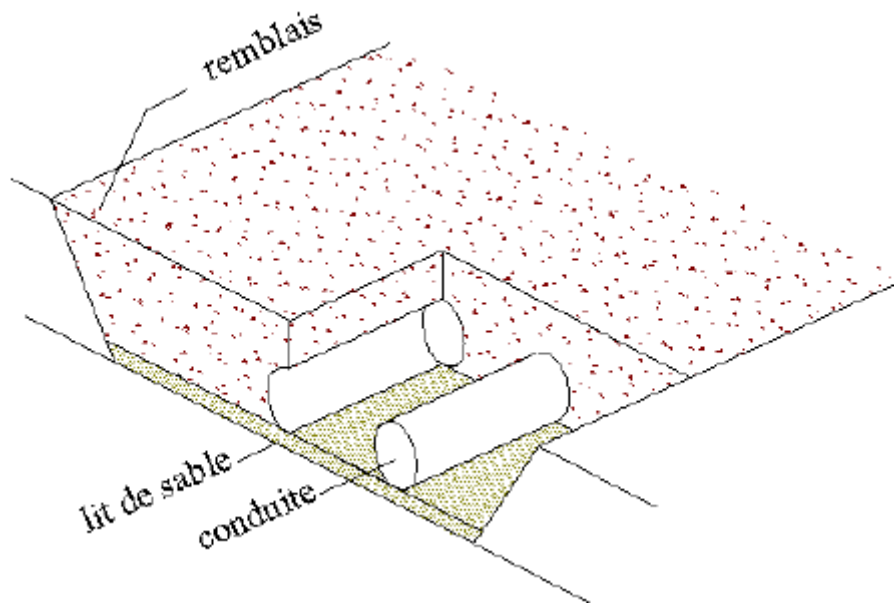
Coupe transversale d'une tranchée avec la mise en place de la conduite.
